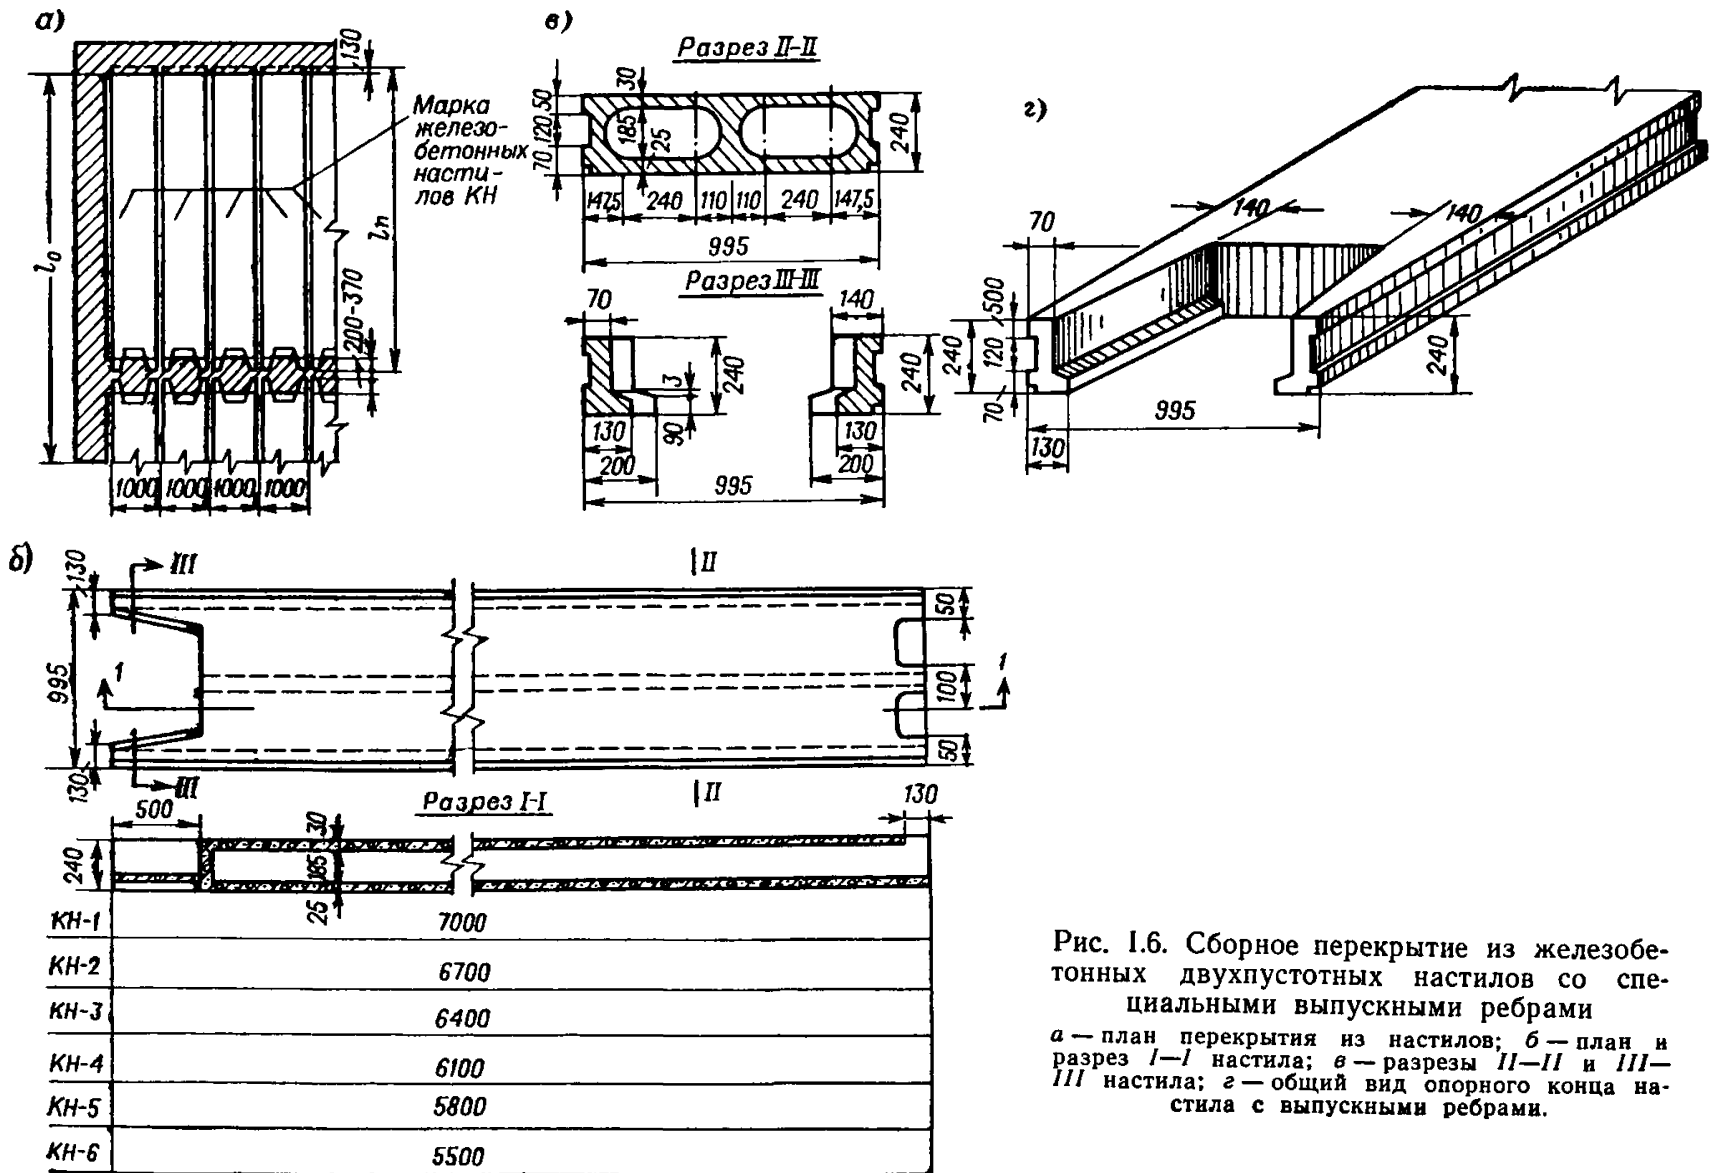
Сборное перекрытие из железобетонных двухпустотных настилов со специальными выпускными ребрами
